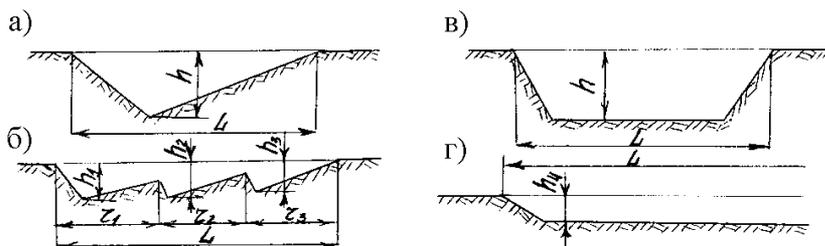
Форма стружек грунта, срезаемых бульдозером:
